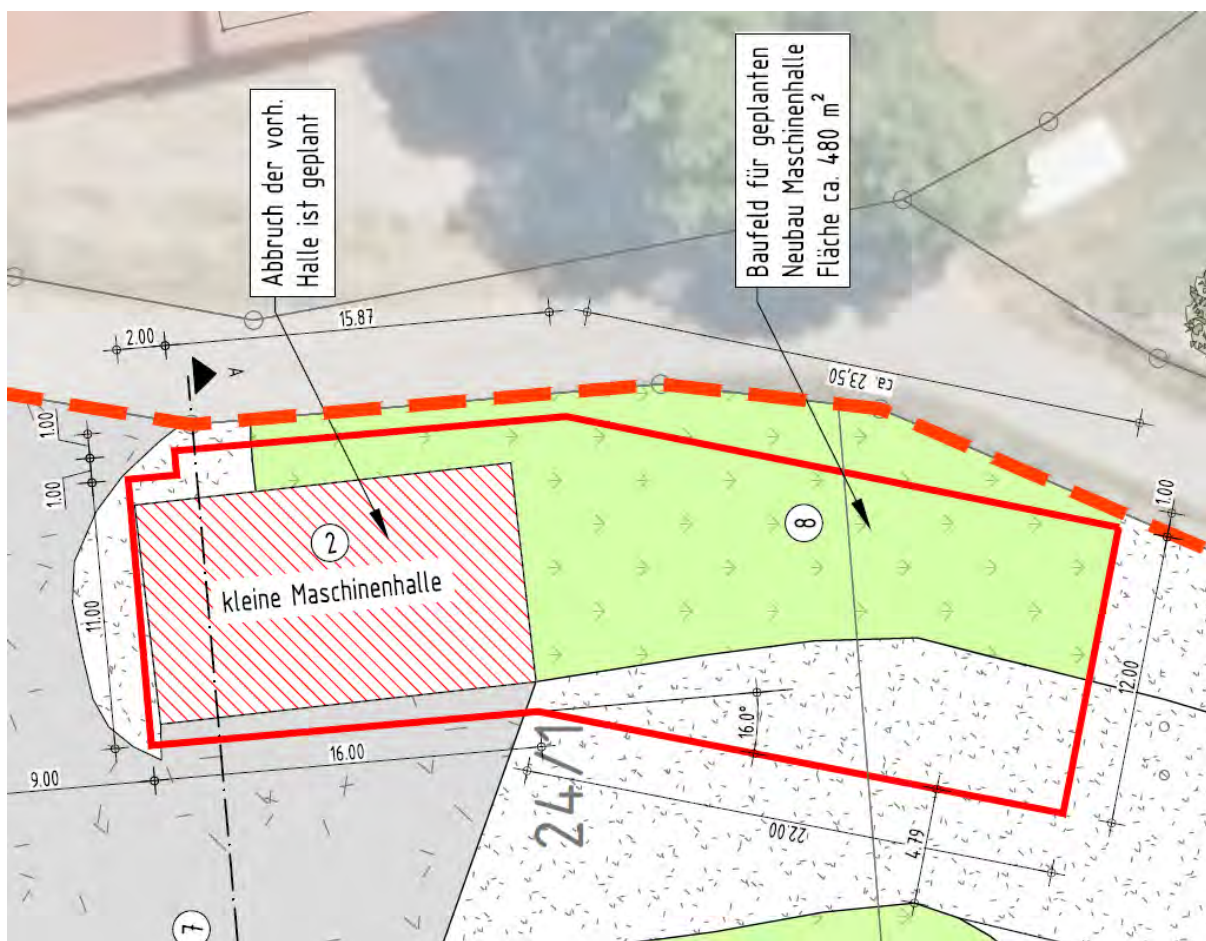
Auszug ohne Maßstab!; Lageplan mit Baufeld für Neubau Maschinenhalle
